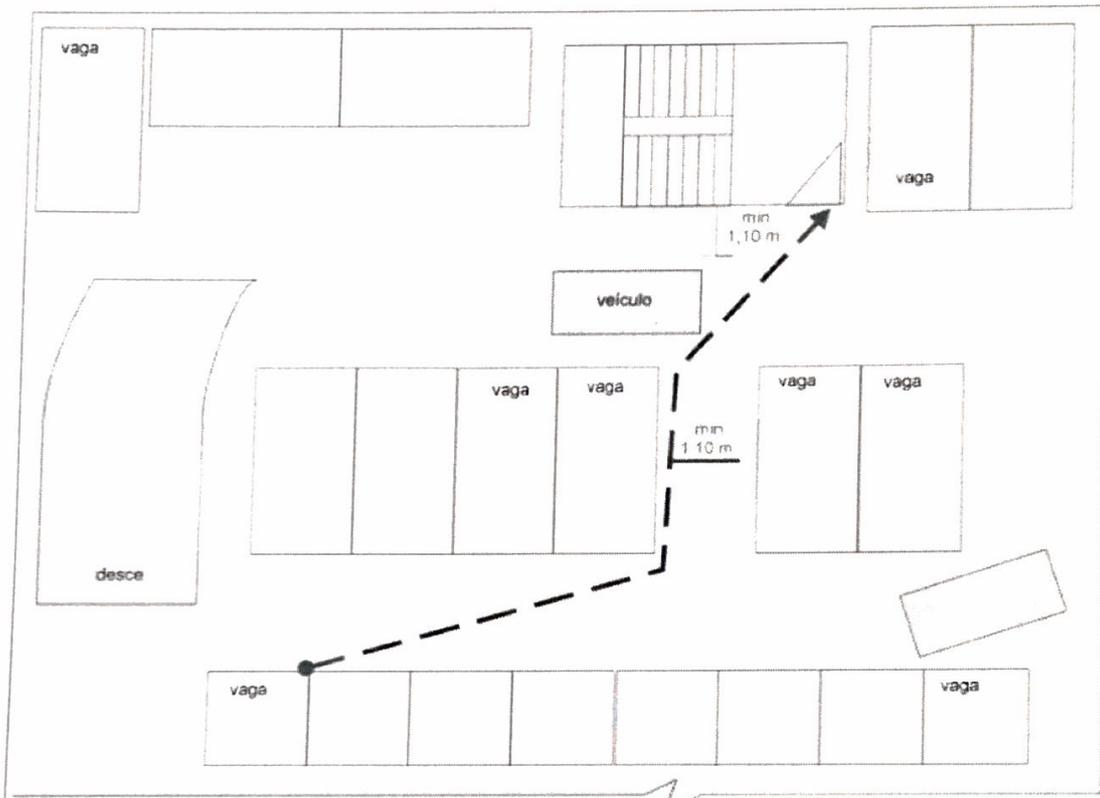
Exemplo para determinação da DMP em pavimentos-garagem.
